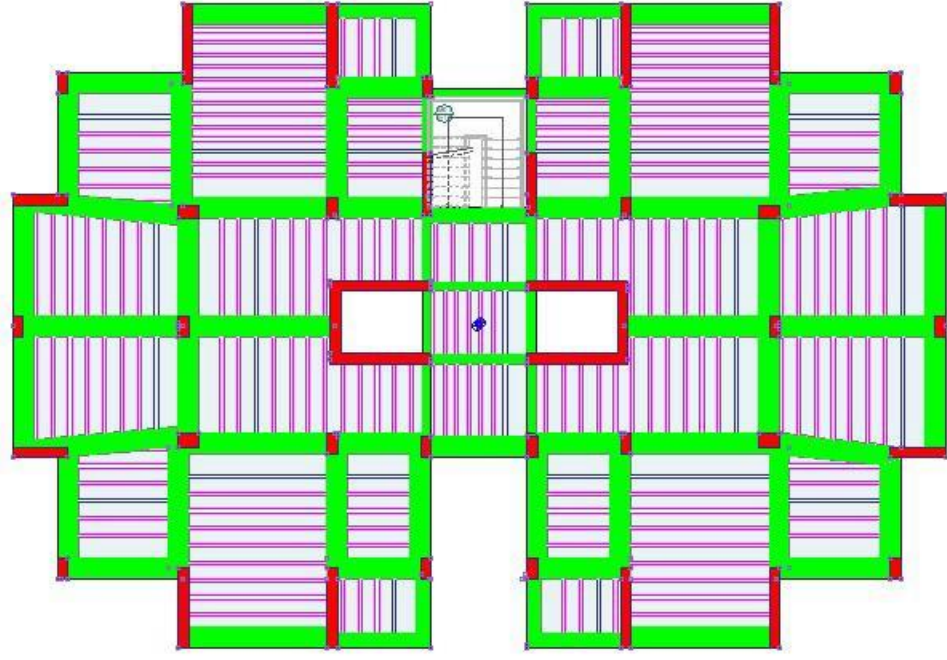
Kirişli döşeme sistemi kalıp planı
